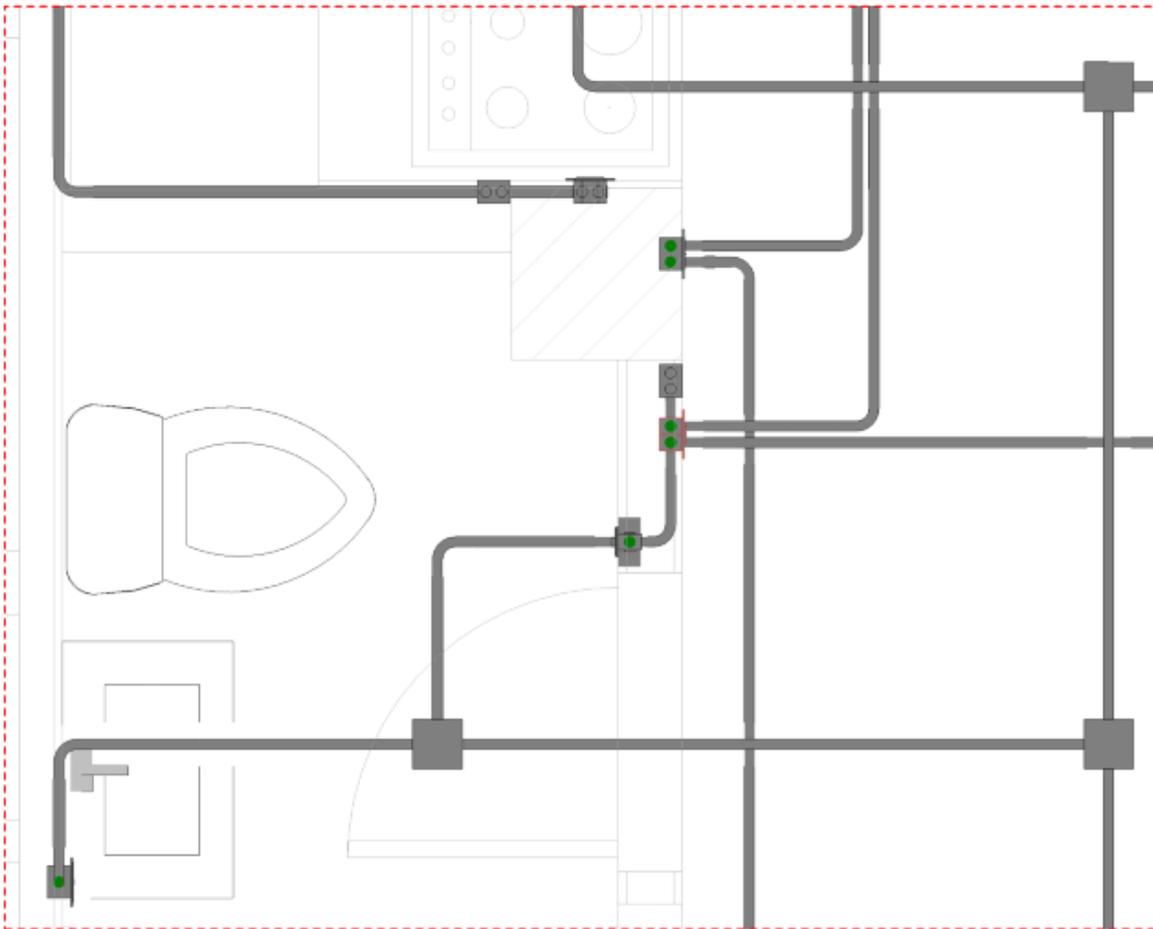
Plano en 2D de la red eléctrica de 2 apartamentos, modelado en Revit.
